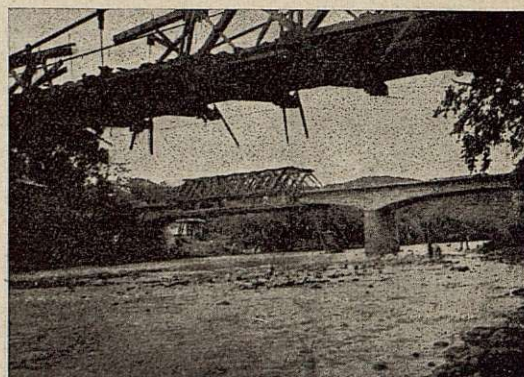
Aspecto general de la obra durante la construcción del tramo central. En primer término el puente viejo, del que se aprecia su lamentable estado.
